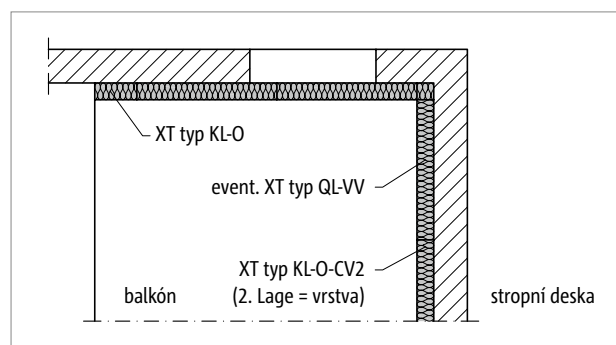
Schöck Isokorb® XT typ KL-U/KL-O: Volně vyložený balkón
